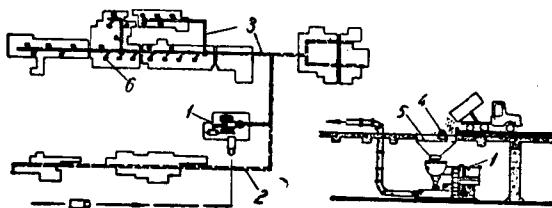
第三個方案——採用混凝土泵來運輸混凝土
